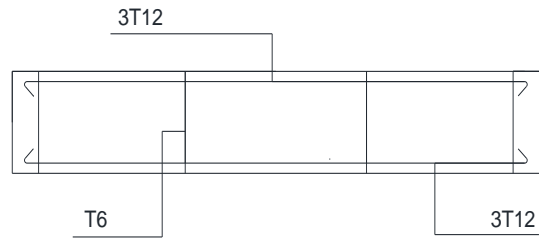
Coupe longitudinale d'une poutre noyée secondaire 15x20cm (plan fortement irrégulier)
